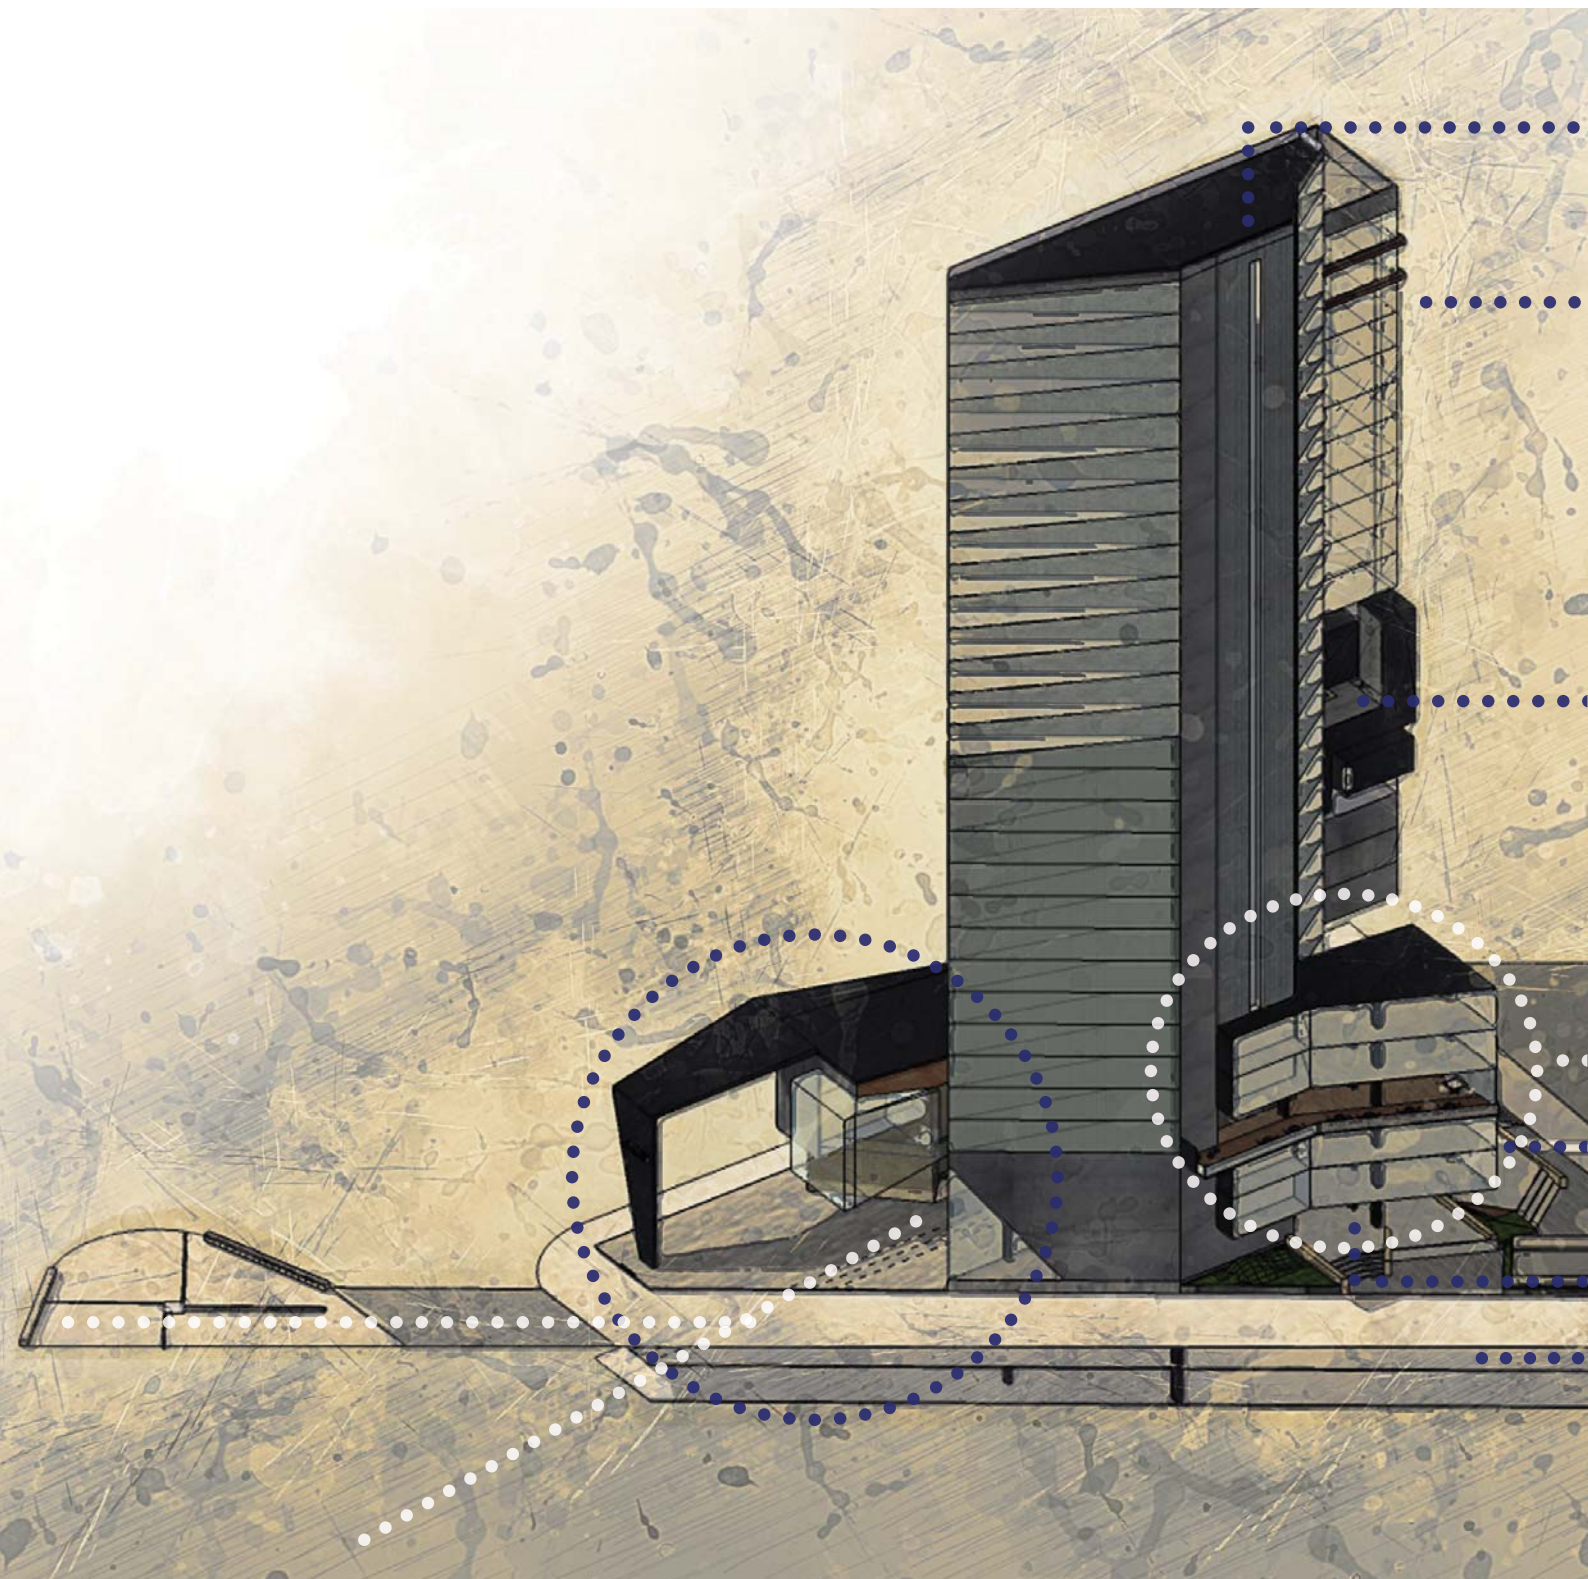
Perspectiva en 3D | Propuesta arquitectónica
